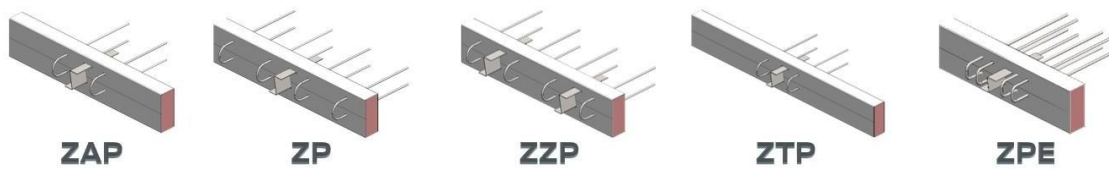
Vue 3D des modèles de traitement des linéaires dalle à prédalle – façade – Procédé Slabe 8
